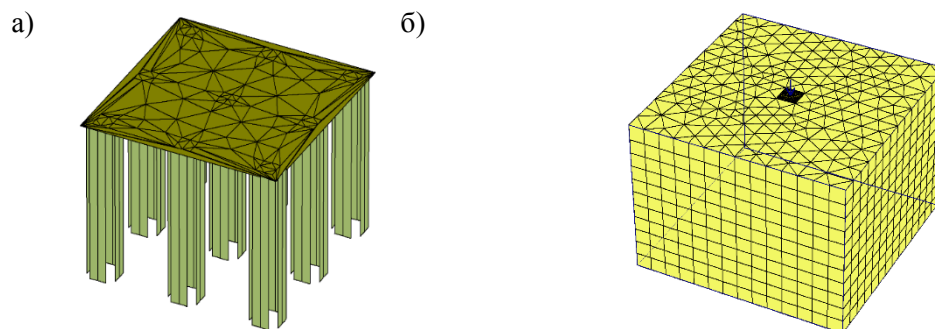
Розрахункові моделі стовпчастого пального фундаменту: а) паливий фундамент, палі довжиною 3 м; б) ґрунтовий масив
